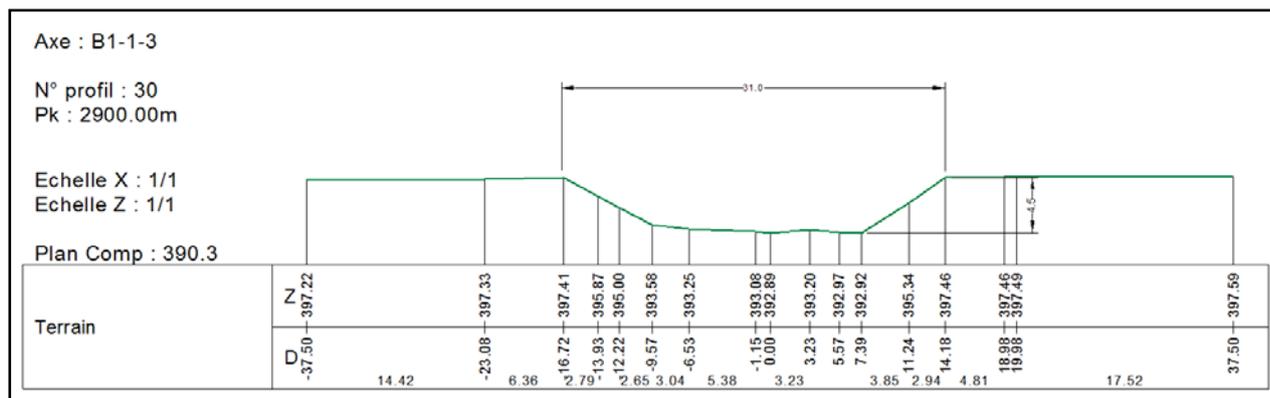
Profil en travers 3 du Guiers Mort à St-Laurent du Pont.
